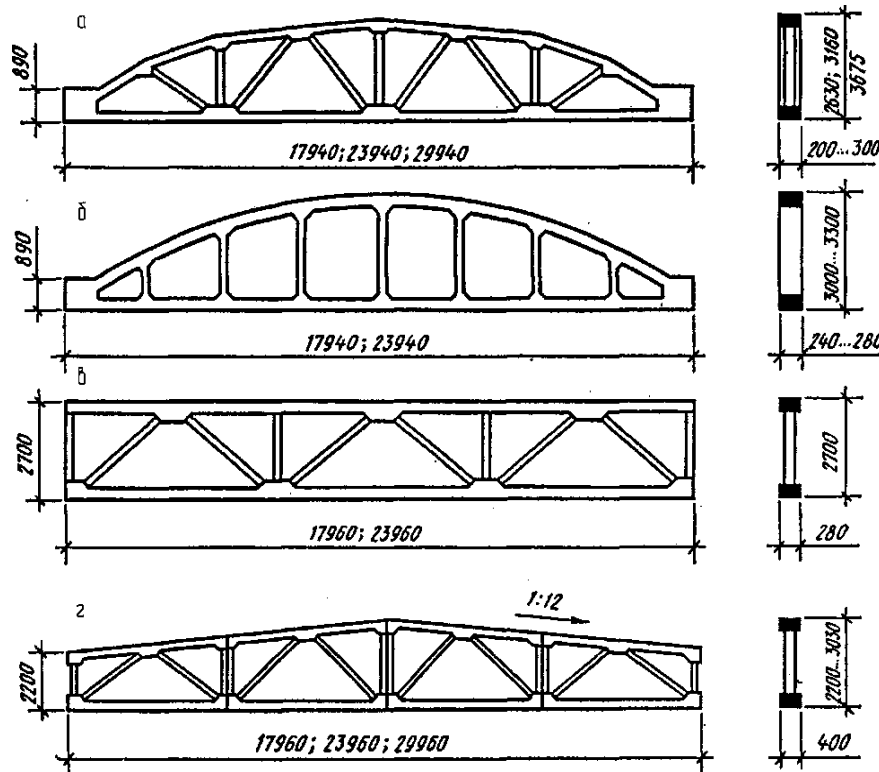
Залізобетонні ферми покриття: а - сегментна; б - аркова безрозкосна; в - з паралельними поясами, г - полігональна.
